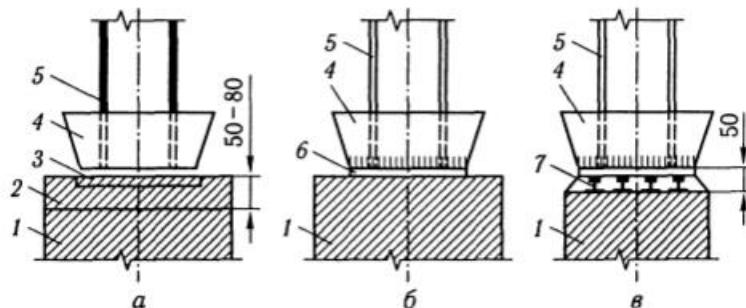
Схеми обпирания металевих колон на фундаменти:
